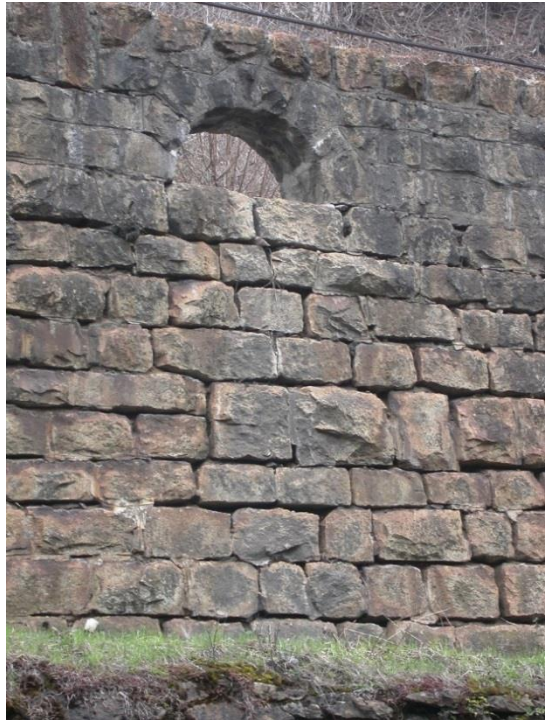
einzelne lose Mauersteine (wegen Mörtelzerfall)
